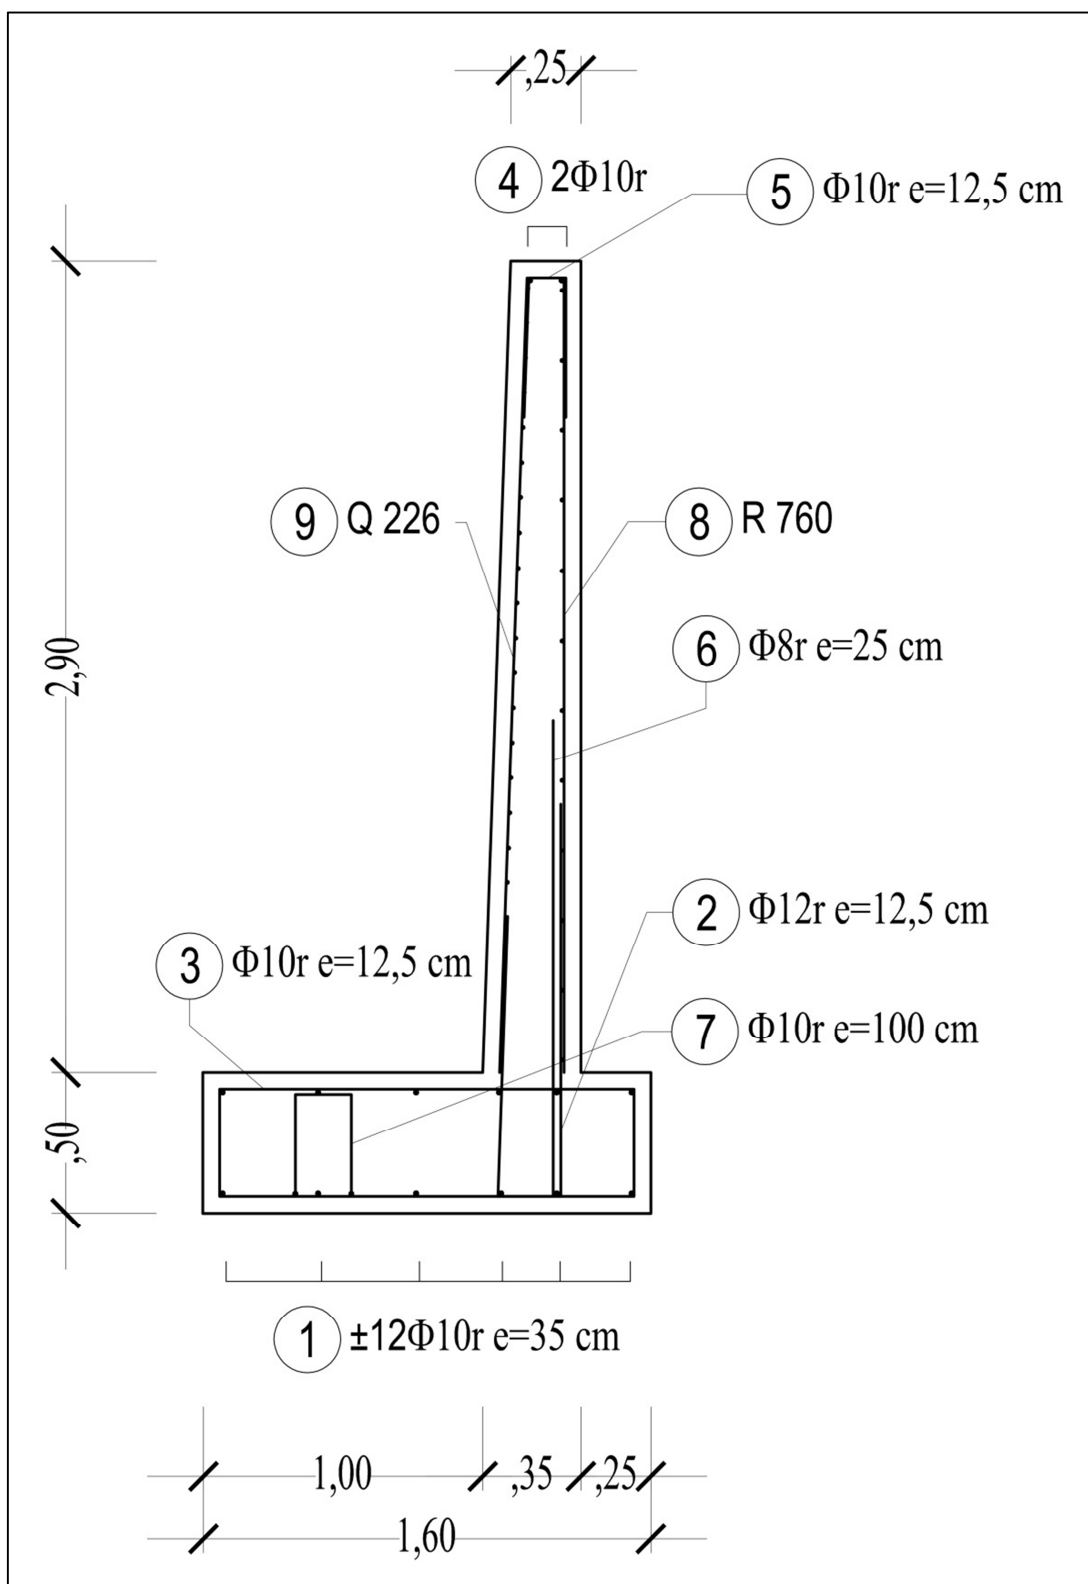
Prerez podporne konstrukcije z vrisano armaturo
